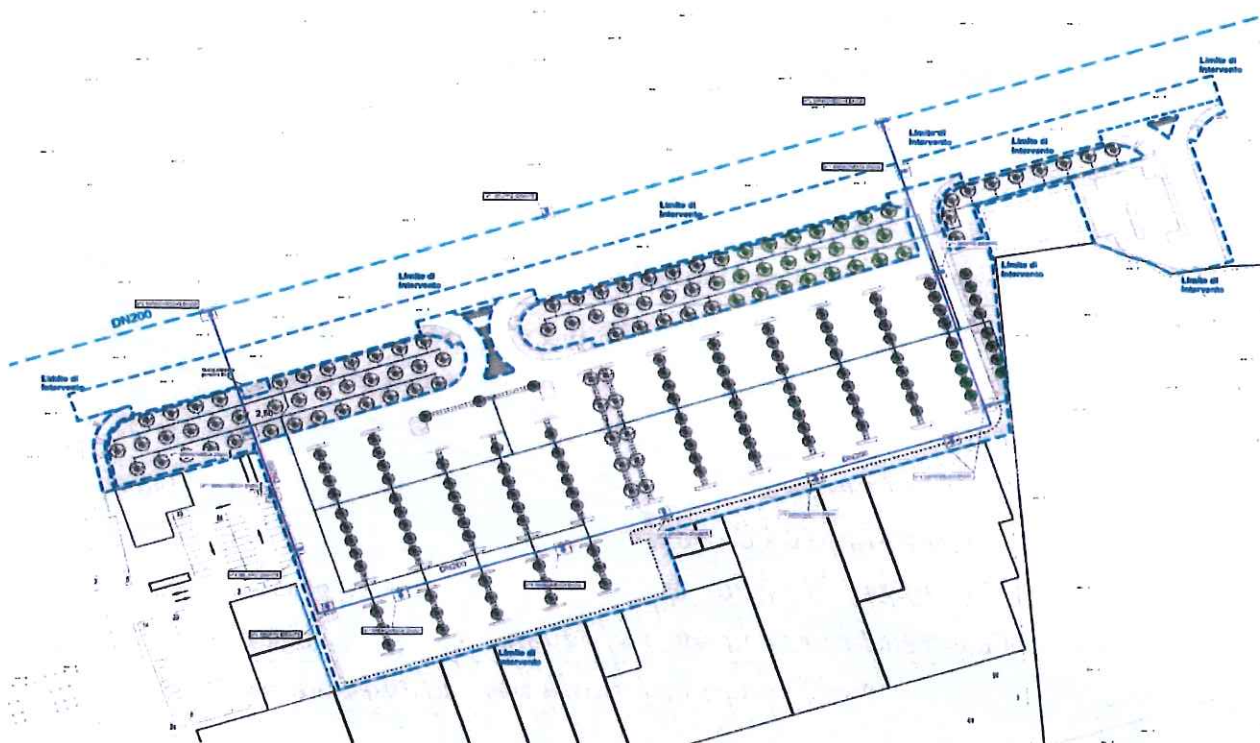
planimetria rete acquedotto ed irrigazione aree a verde
